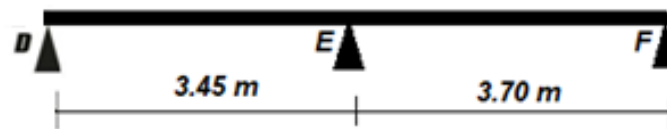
Schéma du 3^{eme} type de poutrelle.
